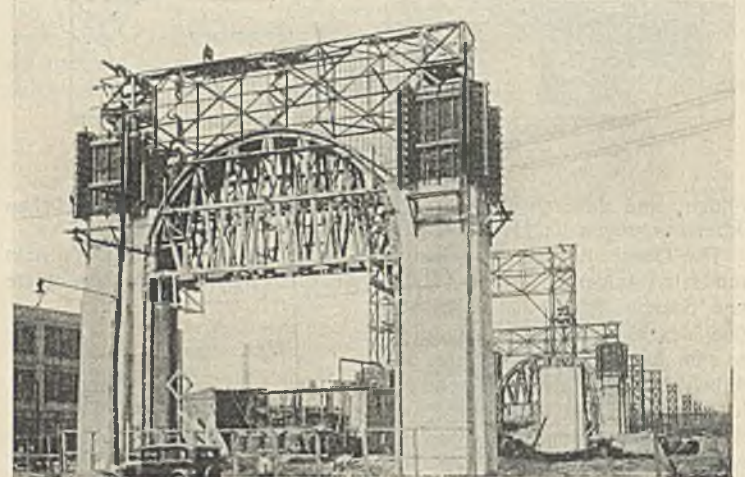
Eisenbetonpfeiler der Rampen (Bayonne, September 1929).
